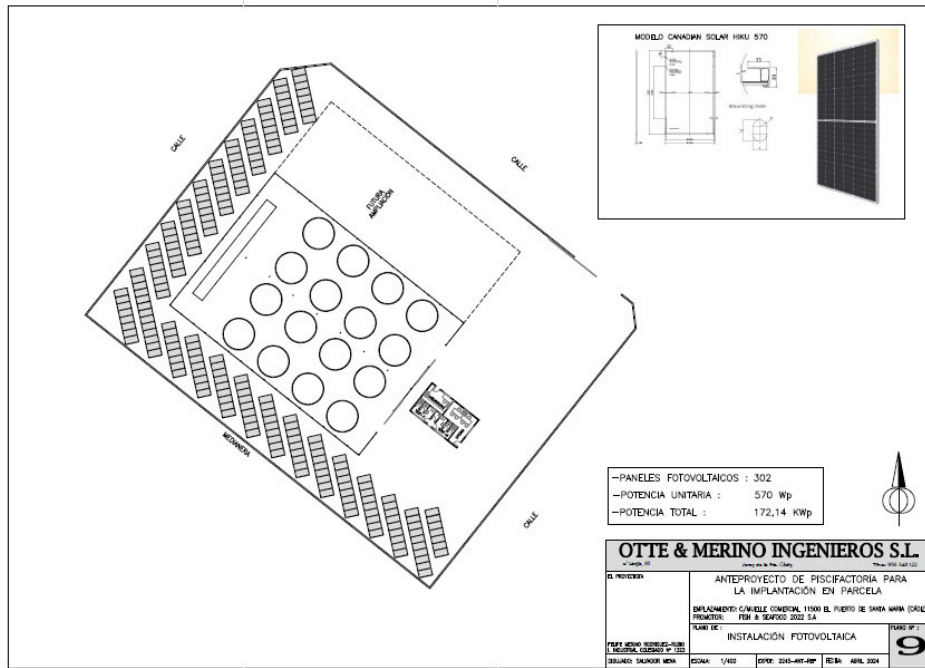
Pan de ordenación de la planta de cultivo RAS
